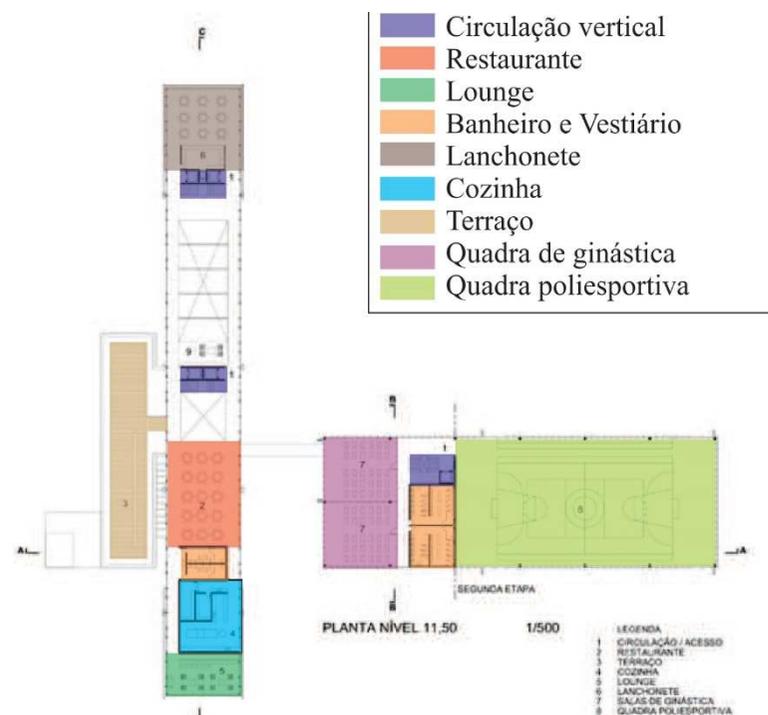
Restaurante localizado sobre a recepção do Clube.
